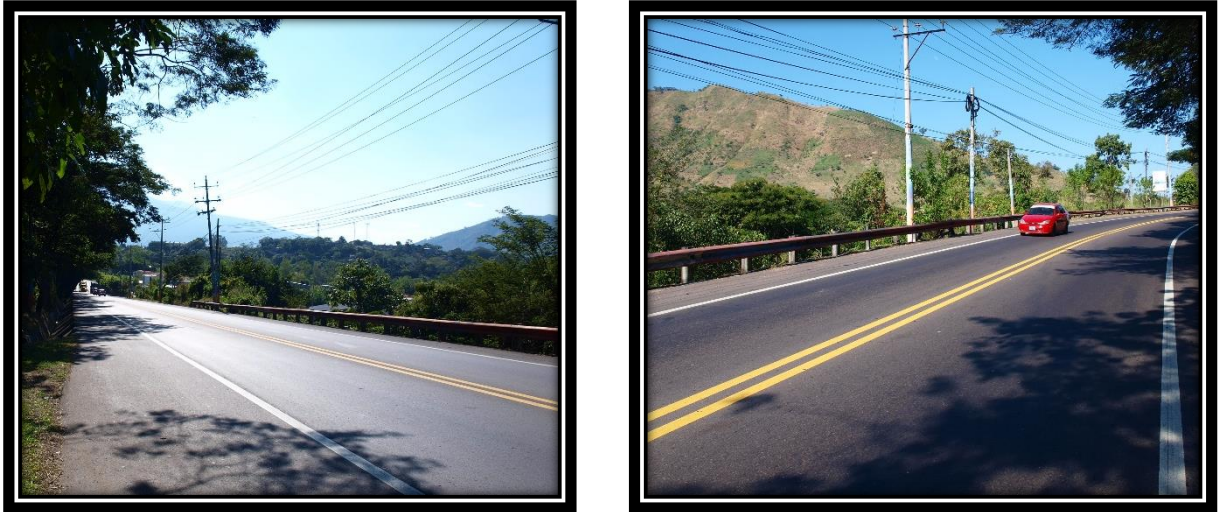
Carretera Troncal del Norte, Pavimentos Flexible
